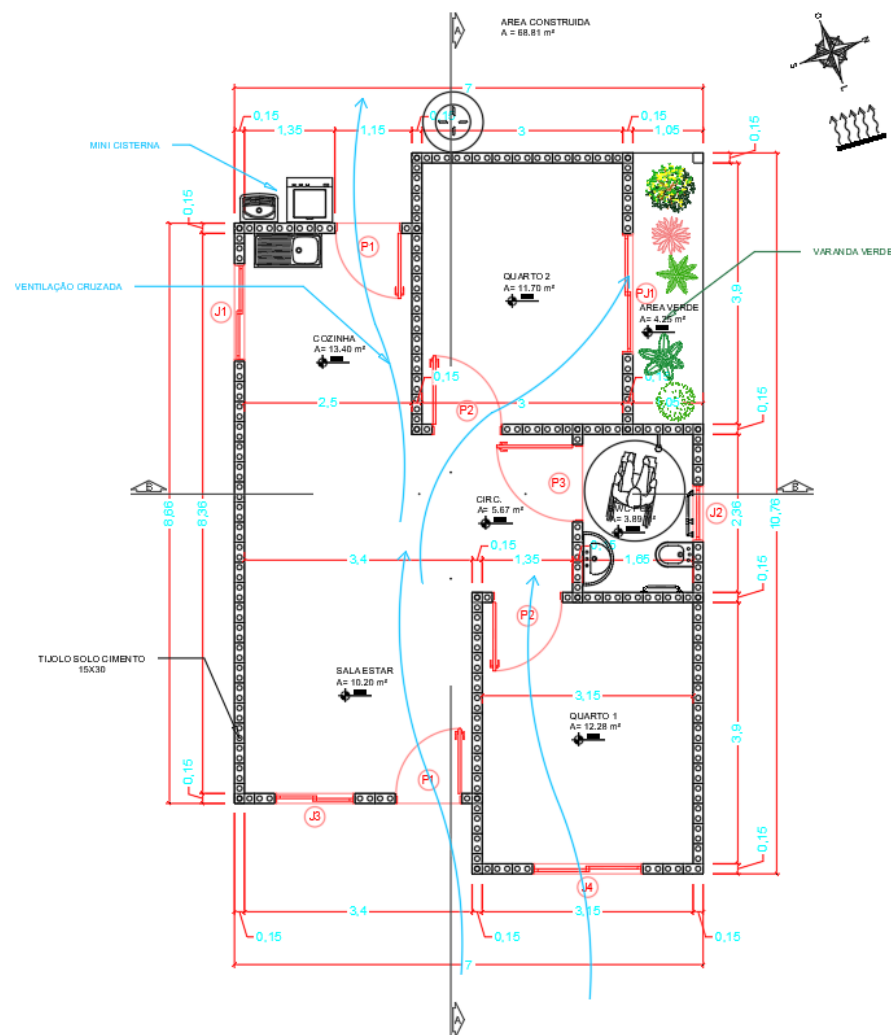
Ventilação dos ambientes (Planta baixa da proposta).
